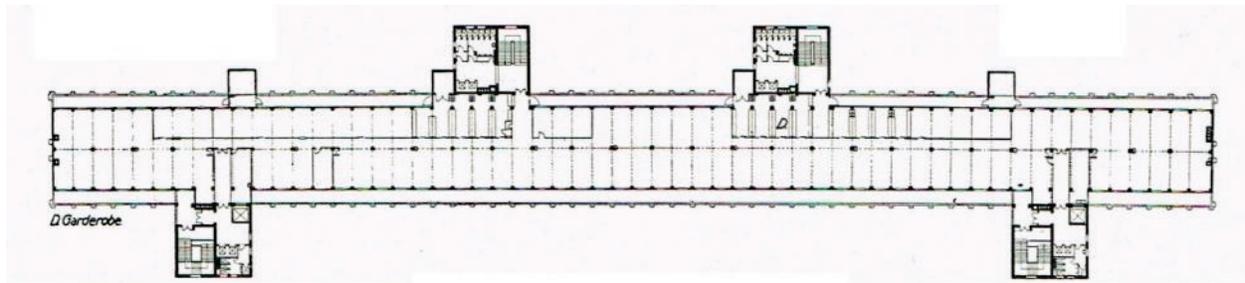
Siemensstadt, Schaltwerkhochhaus und Wernerwerk II, Systemgrundrisse und Erschließung, Quelle: Hertlein 1929 / 1933
